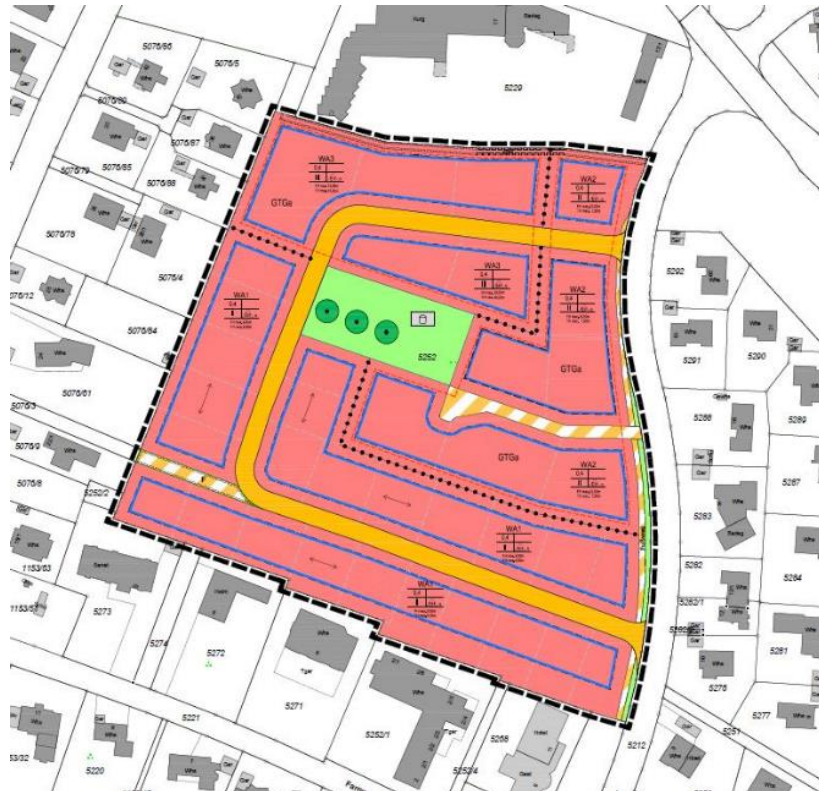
Bebauungsplan "Oberförster-Ganter-Straße", Stadt Villingen-Schwenningen
